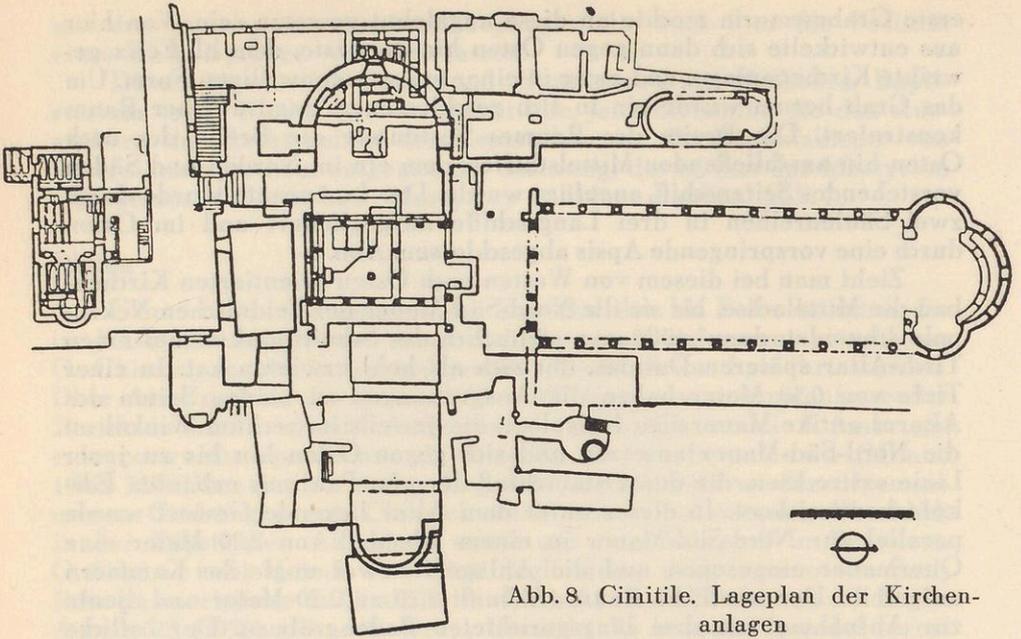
Cimitile. Lageplan der Kirchenanlagen
